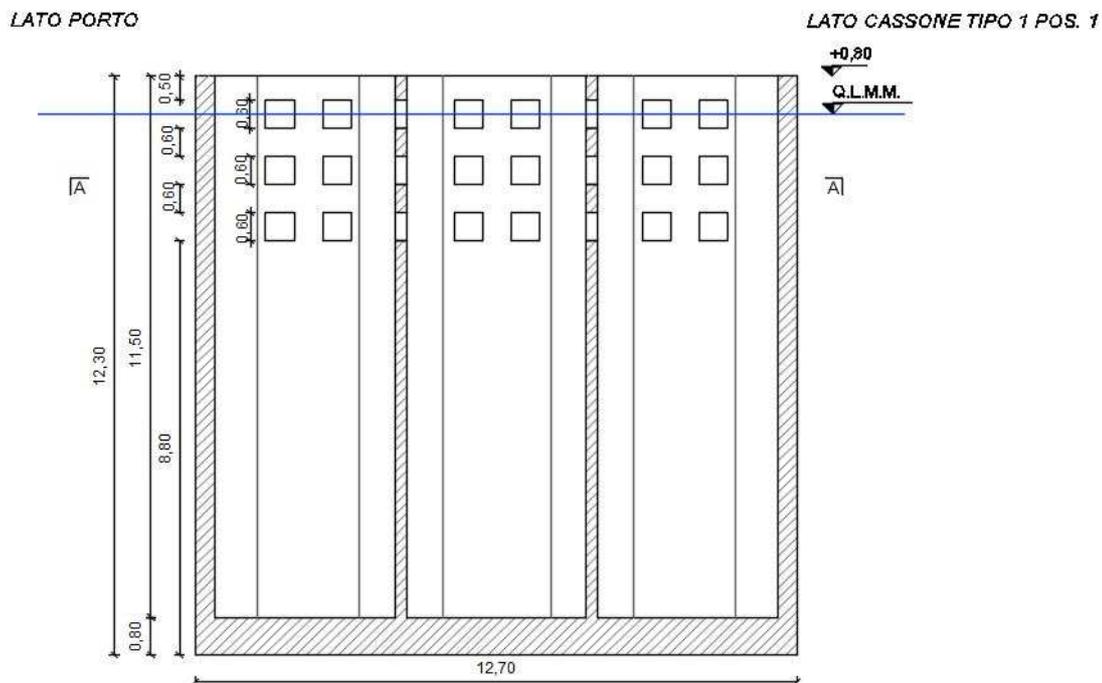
Cassone tipo 3: Carpenteria - Sezione verticale trasversale D-D
